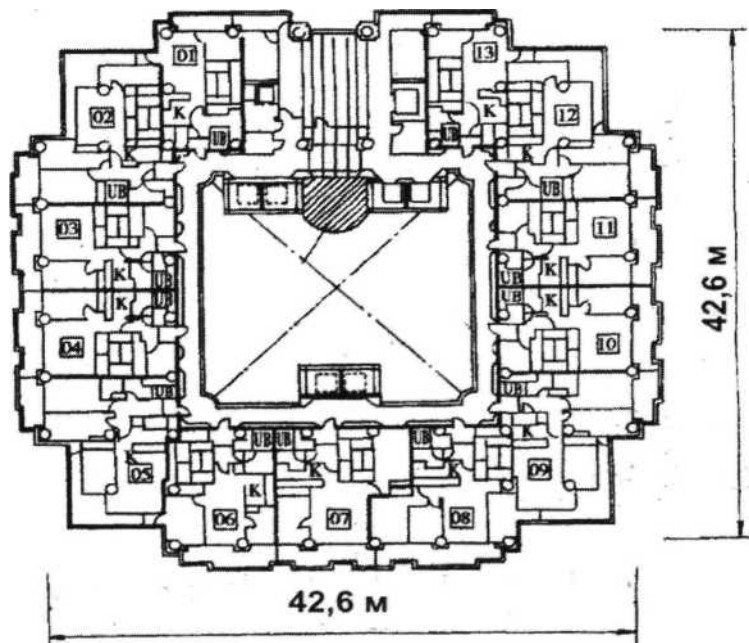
План висотного житлового будинку з трубобетонних колонамим Кавагучі, Японія
